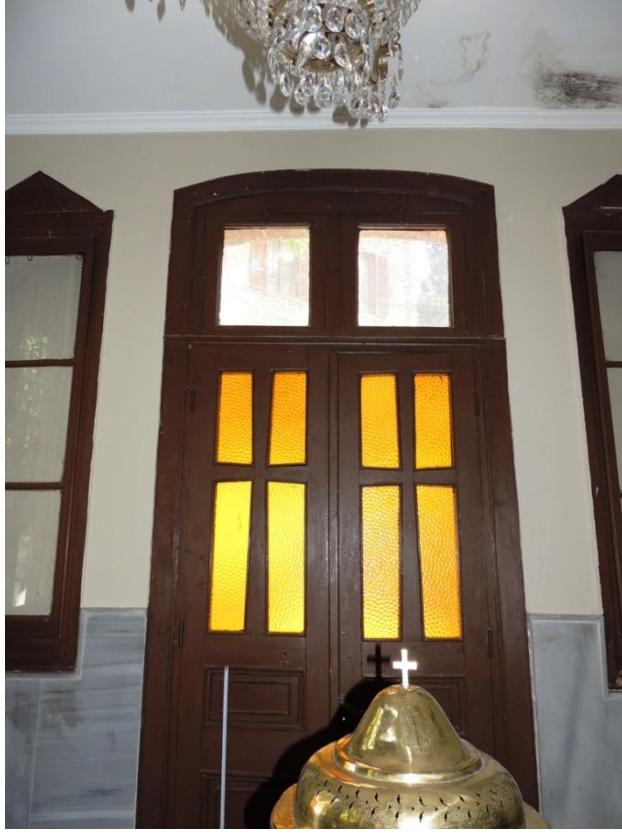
Kilisenin bugün kullanılan giriş kapısı.
